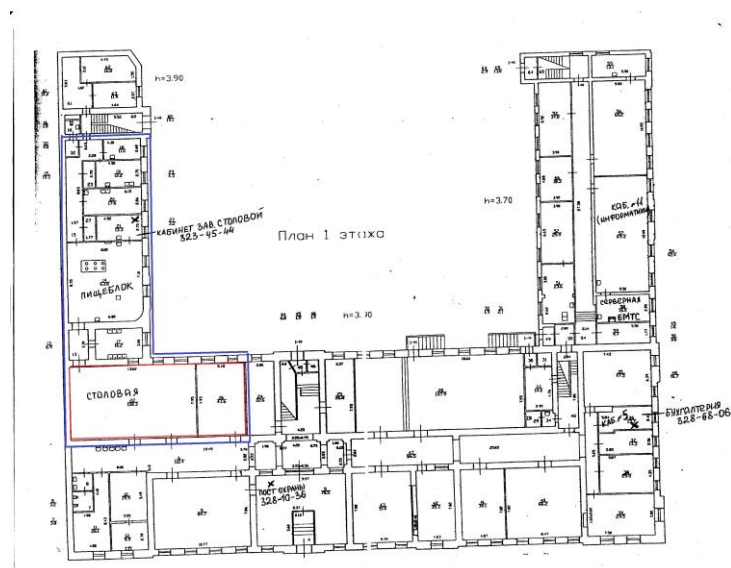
План первого этажа ГБОУ гимназии № 24 им. И.А Крылова
